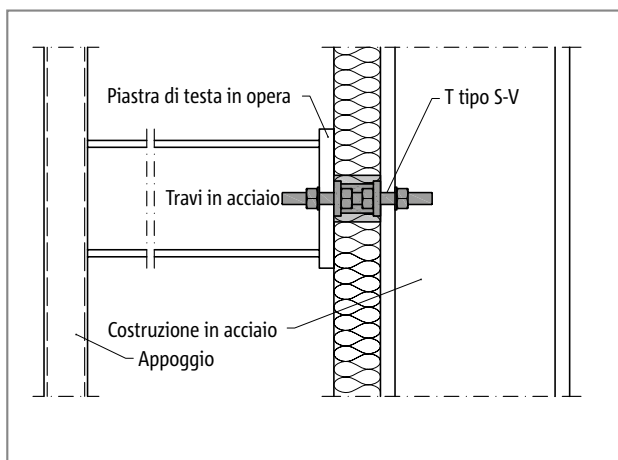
Schöck Isokorb® T tipo S-V: costruzione in acciaio in semplice appoggio
